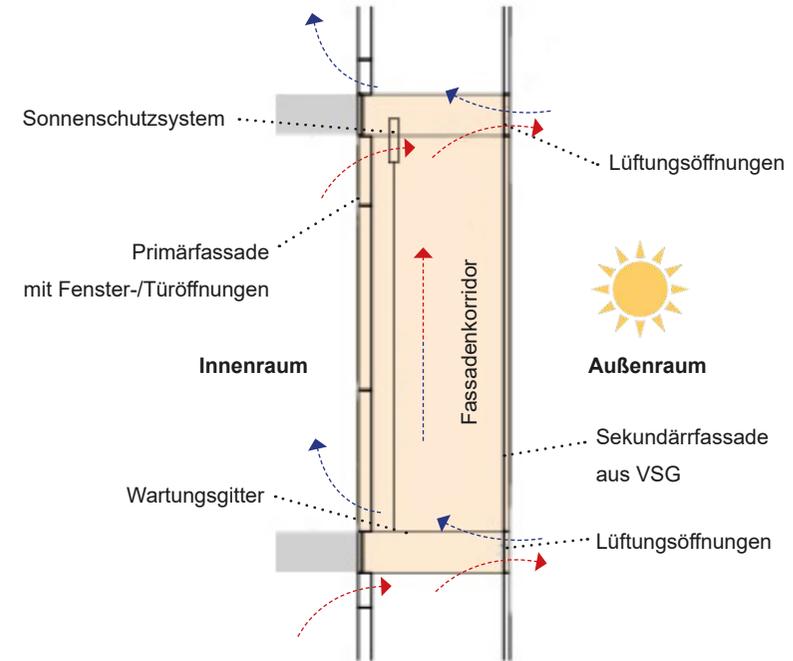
Eigene Darstellung: Vertikalfassadenschnitt - Doppelfassade
